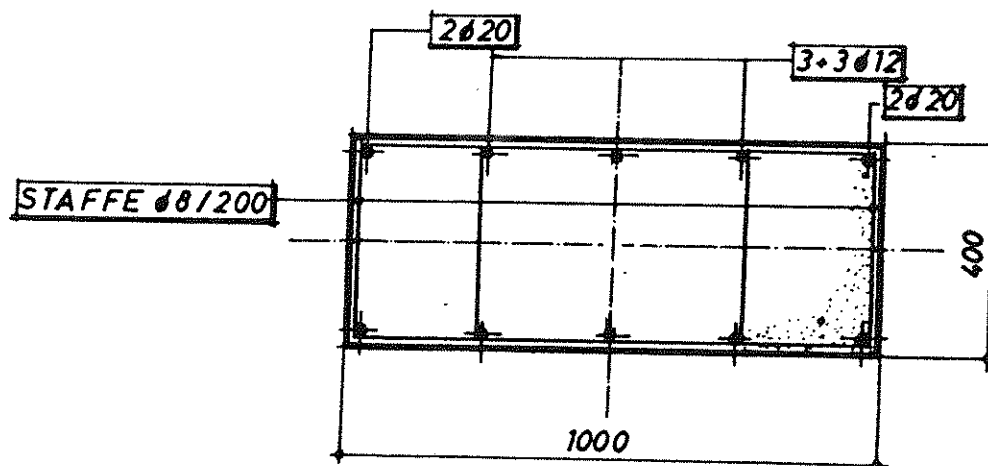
Caratteristiche geometriche e disposizione della armatura per i pilastri di bordo
